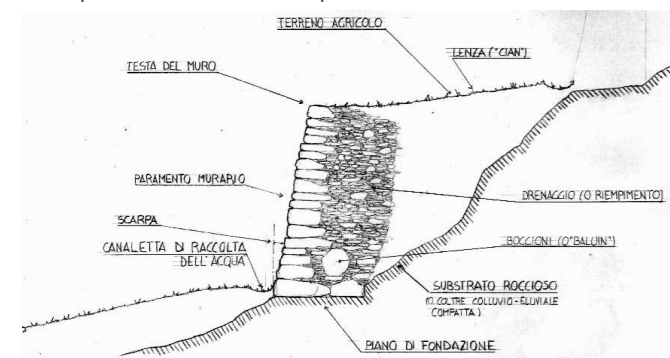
Stratigrafia tipo di un muretto a secco, foto presa da [www.ruralpini.it](http://www.ruralpini.it)
